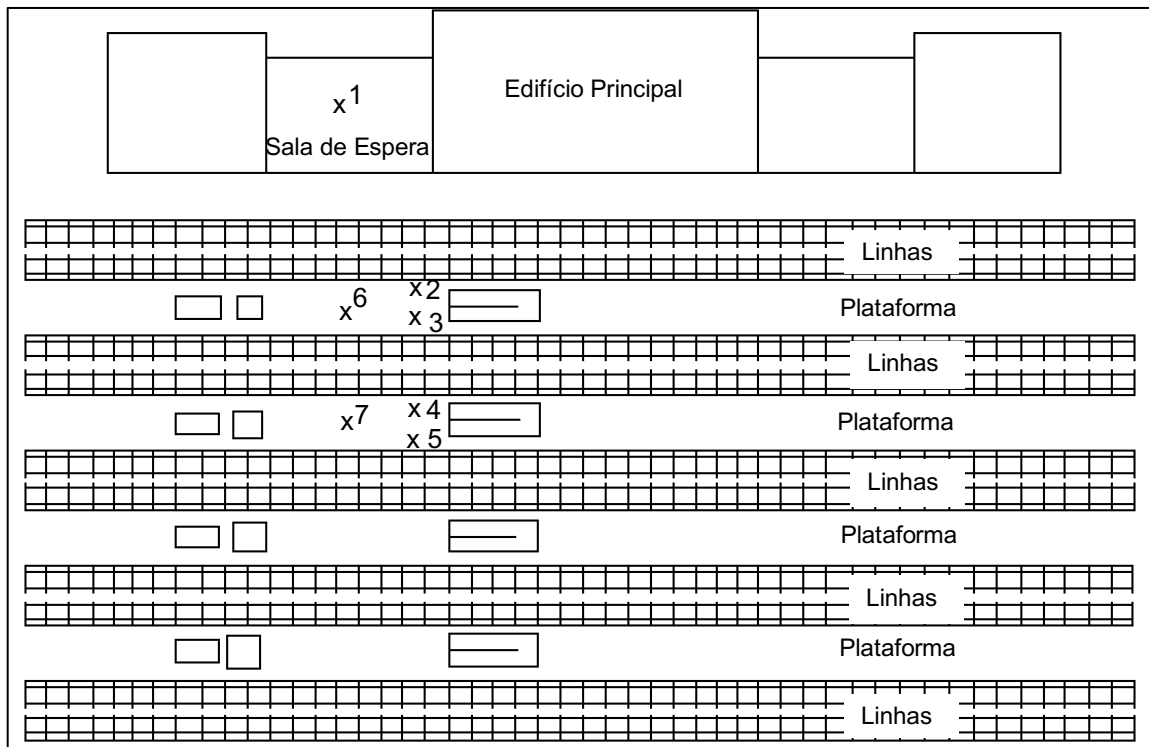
Corte da planta (sem escala) da estação ferroviária de Campanhã, com os 7 pontos de medição.
